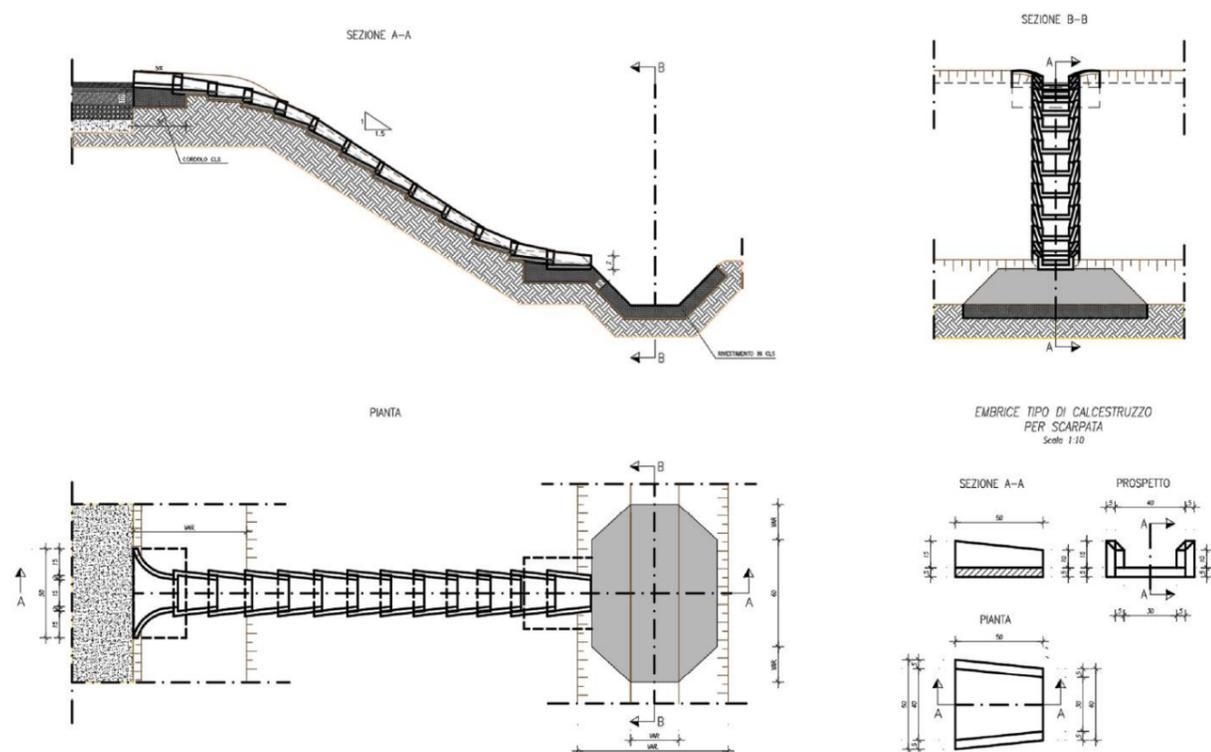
Dettaglio degli embrici in pianta e in sezione
